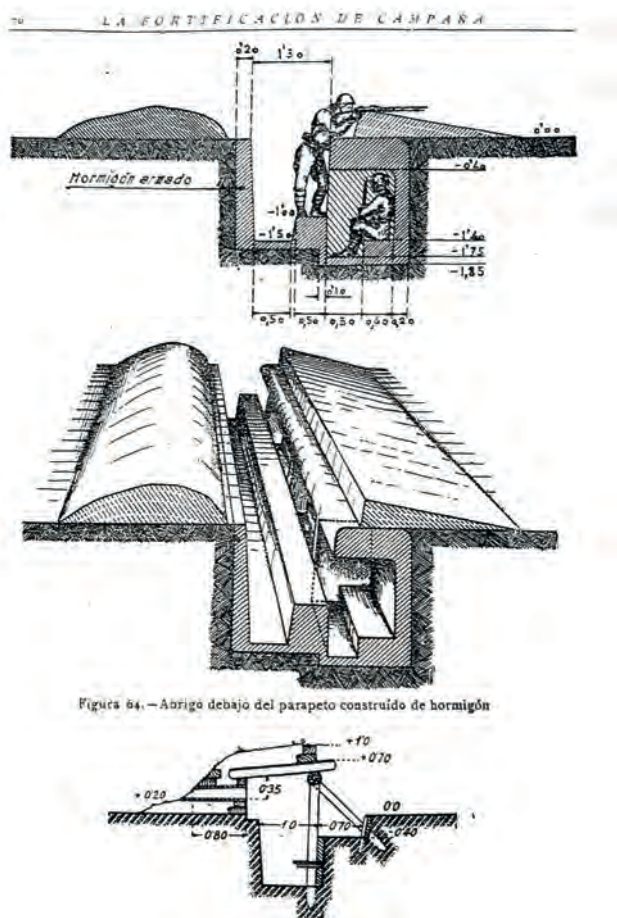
Adrigo debajo del parapeto construido de hormigón
